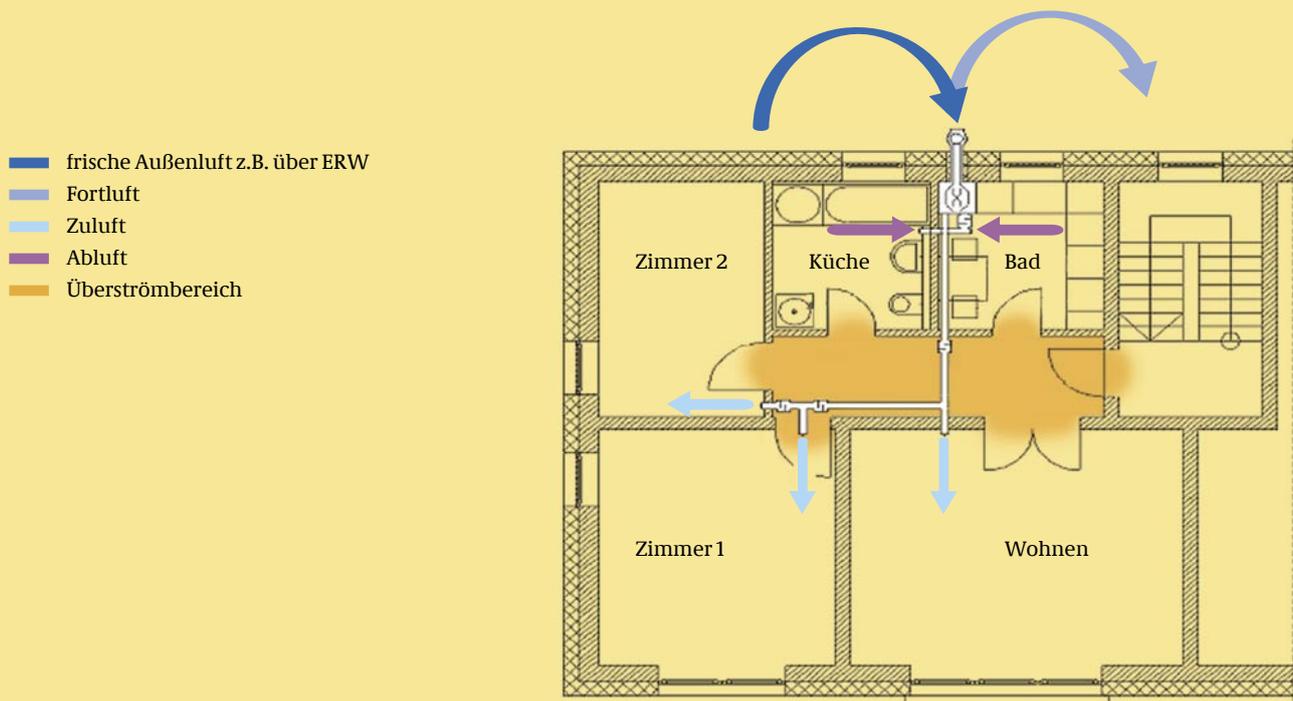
Zu-/Abluftanlage mit WRG (Grundriss)
